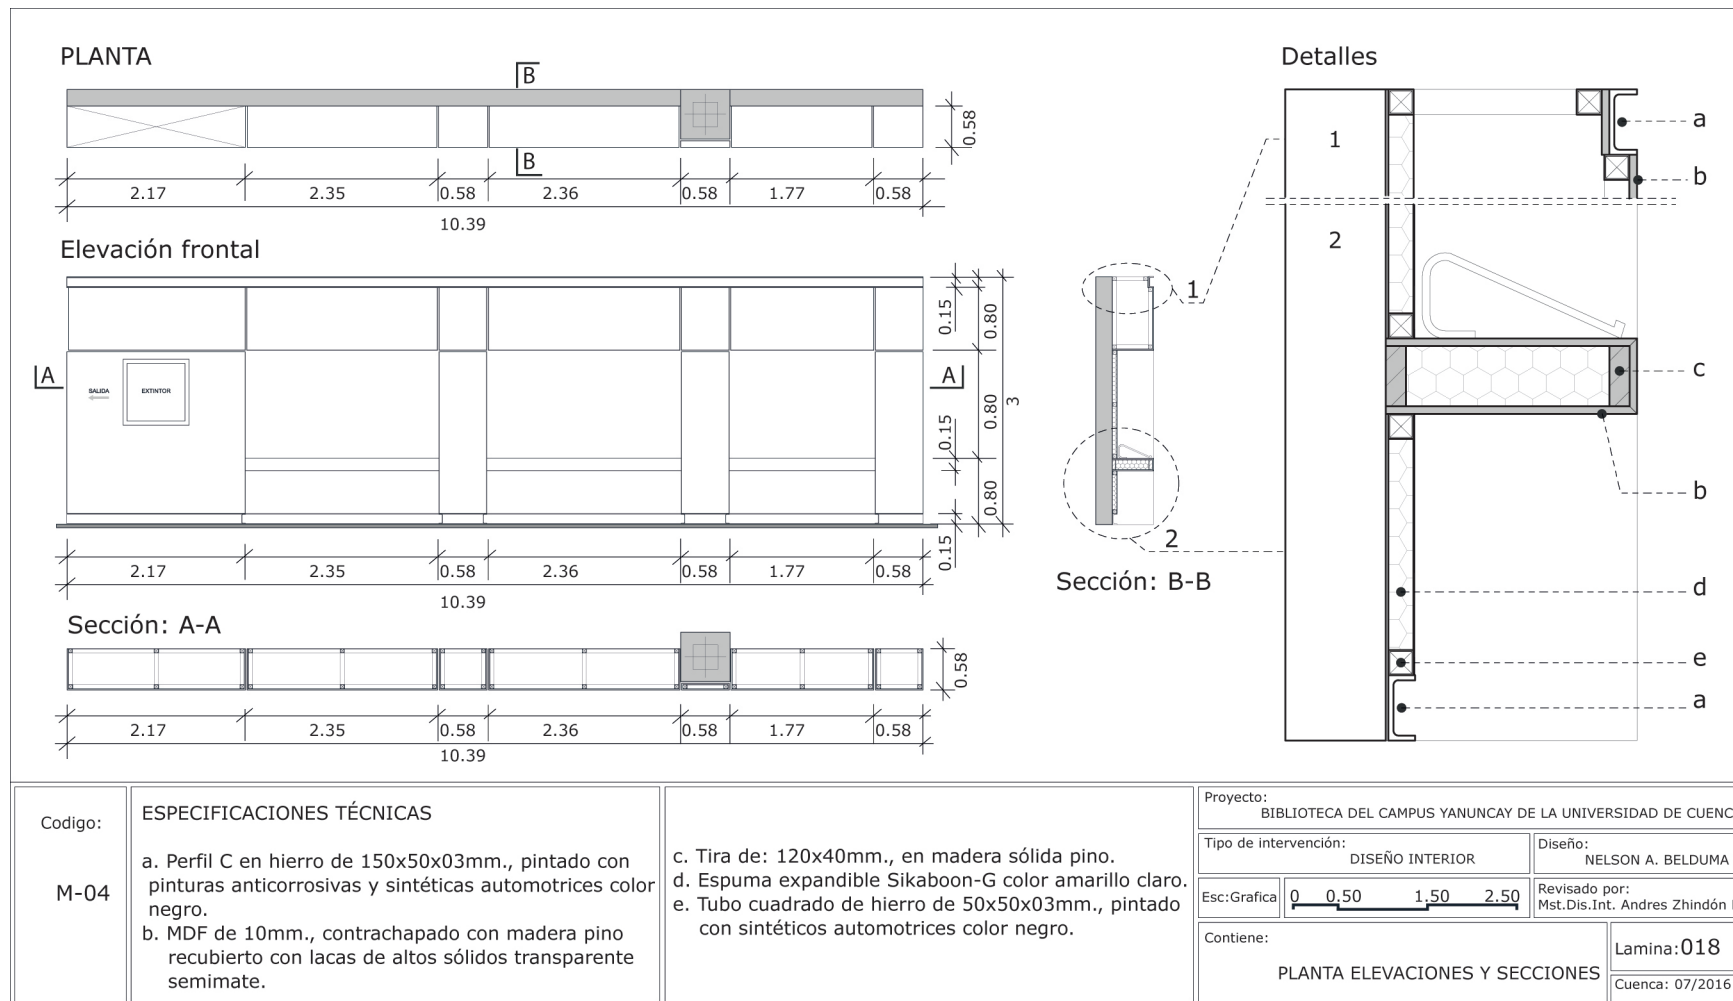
Planta, elevaciones y secciones. Sala de lectura. M-04.
